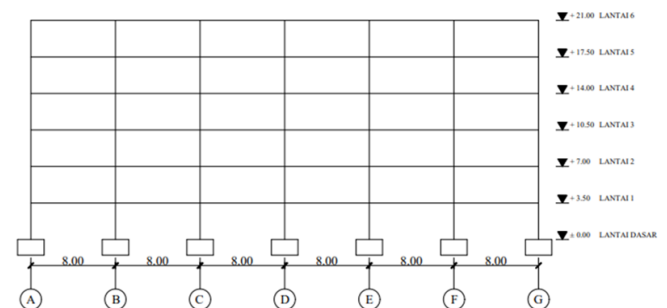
Denah Struktur Bangunan A dengan Seluruh Kolom Elastis Berada di Bagian Eksterior Struktur
